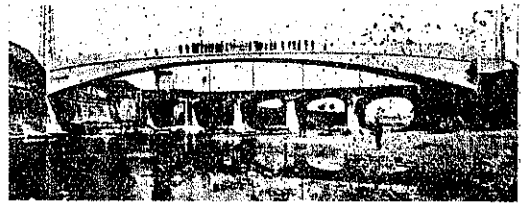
Pisa 市 Bisenzio 河歩道橋 (側面図)
